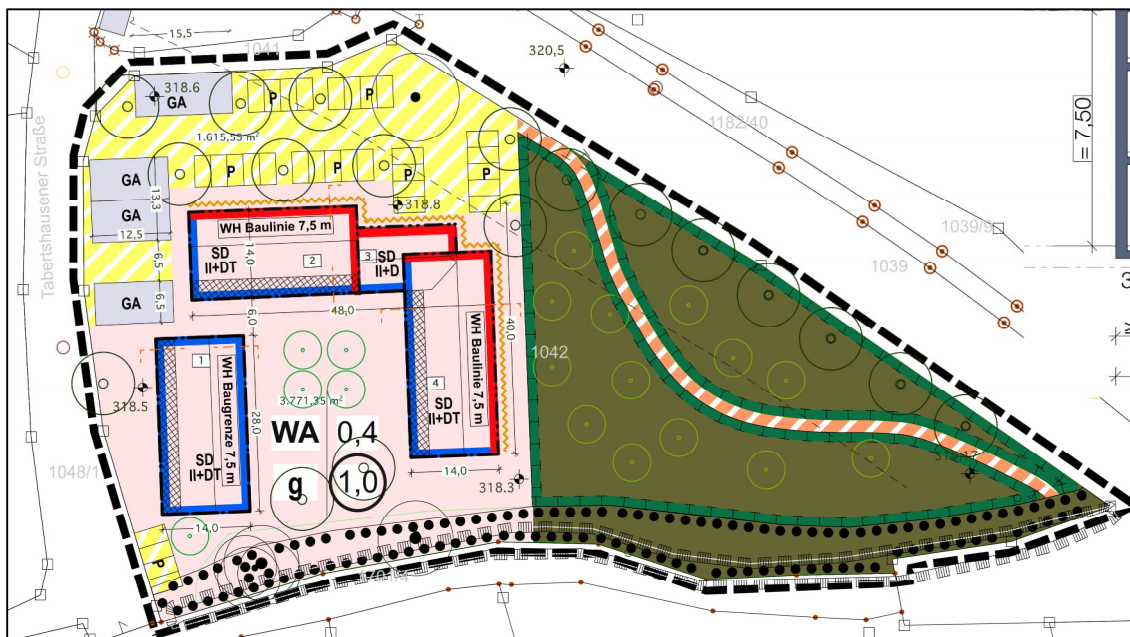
Bebauungsplan "Tabertshausener Straße – Isarkarree" der Stadt Plattling /11/
